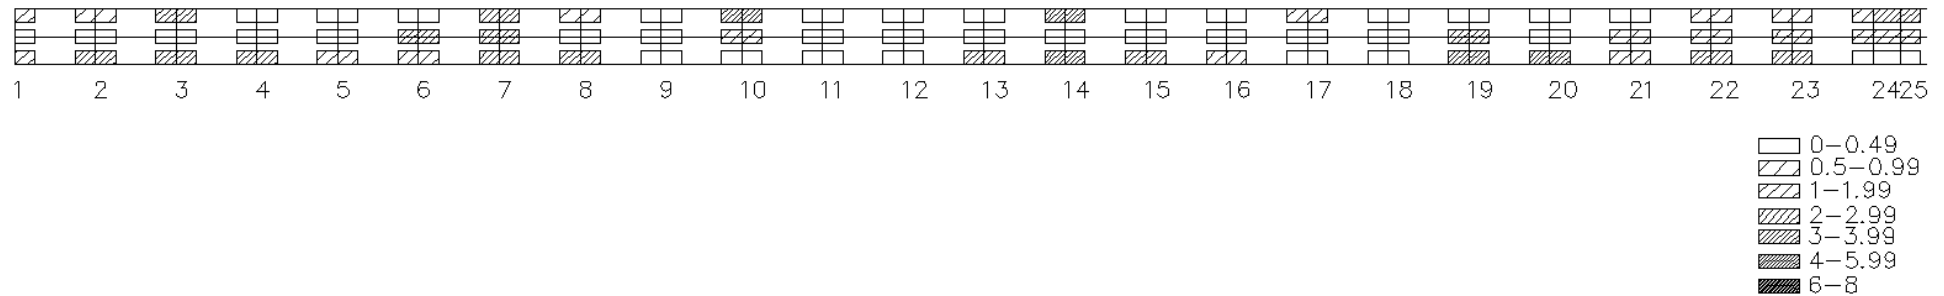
Frästiefen bei kubischer Splinefunktion und Verfahrensplan Typ C, Grundriss, Stationen 1-25
